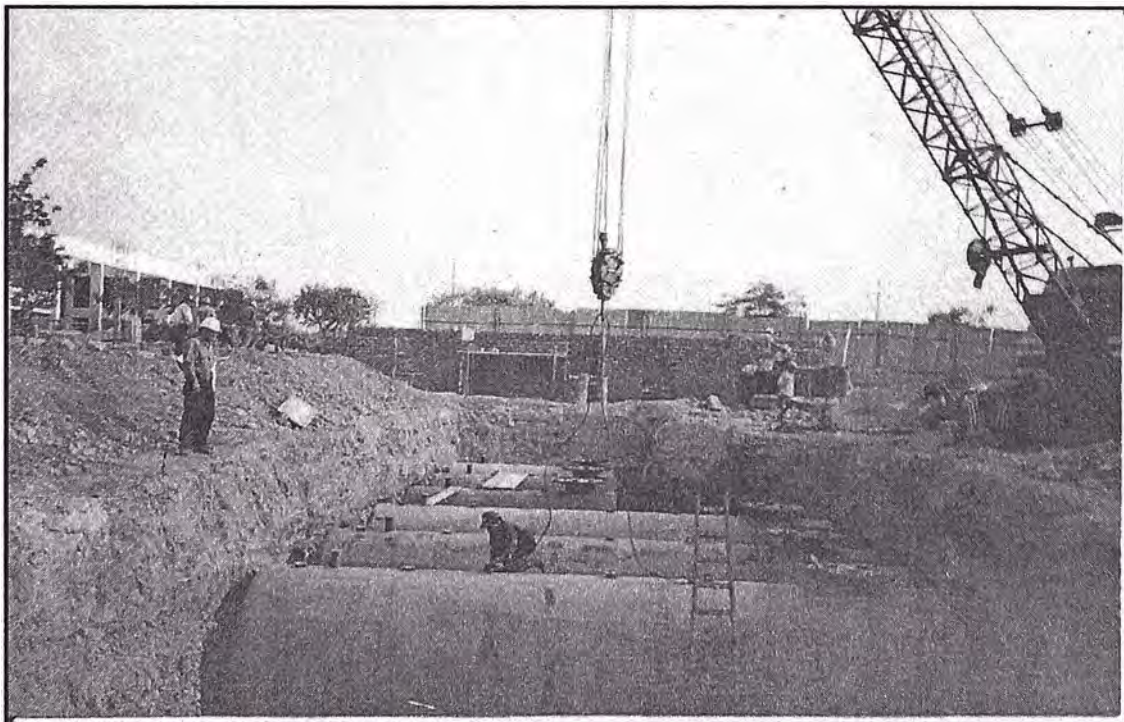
Así sucesivamente se van colocando los tanques, por el fondo otra cuadrilla sigue con el levantamiento de muros hasta la altura de la loza aligerada en la zona de servicios.
